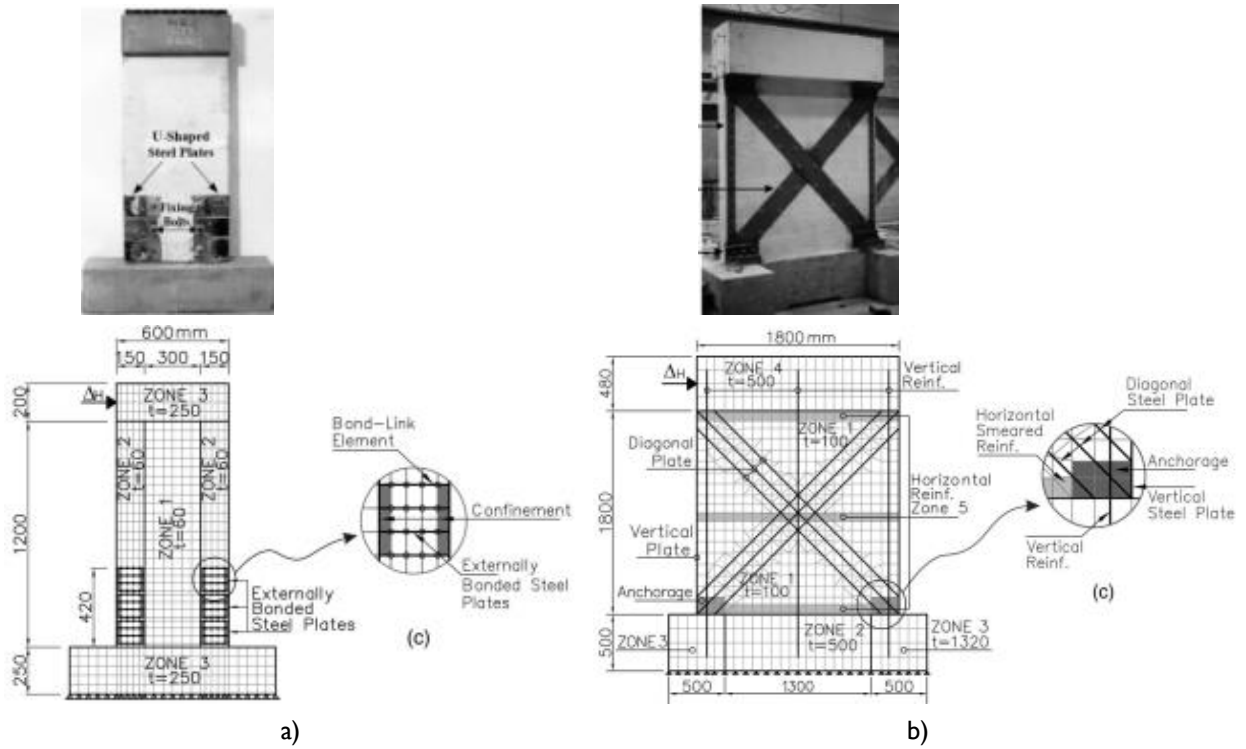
Detalle de modelización según Cortés-Puentes y Palermo [32]; a) muro SW32, b) muro W11R.
